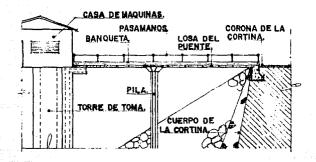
PUENTE DE ACCESO A LA OBRA
